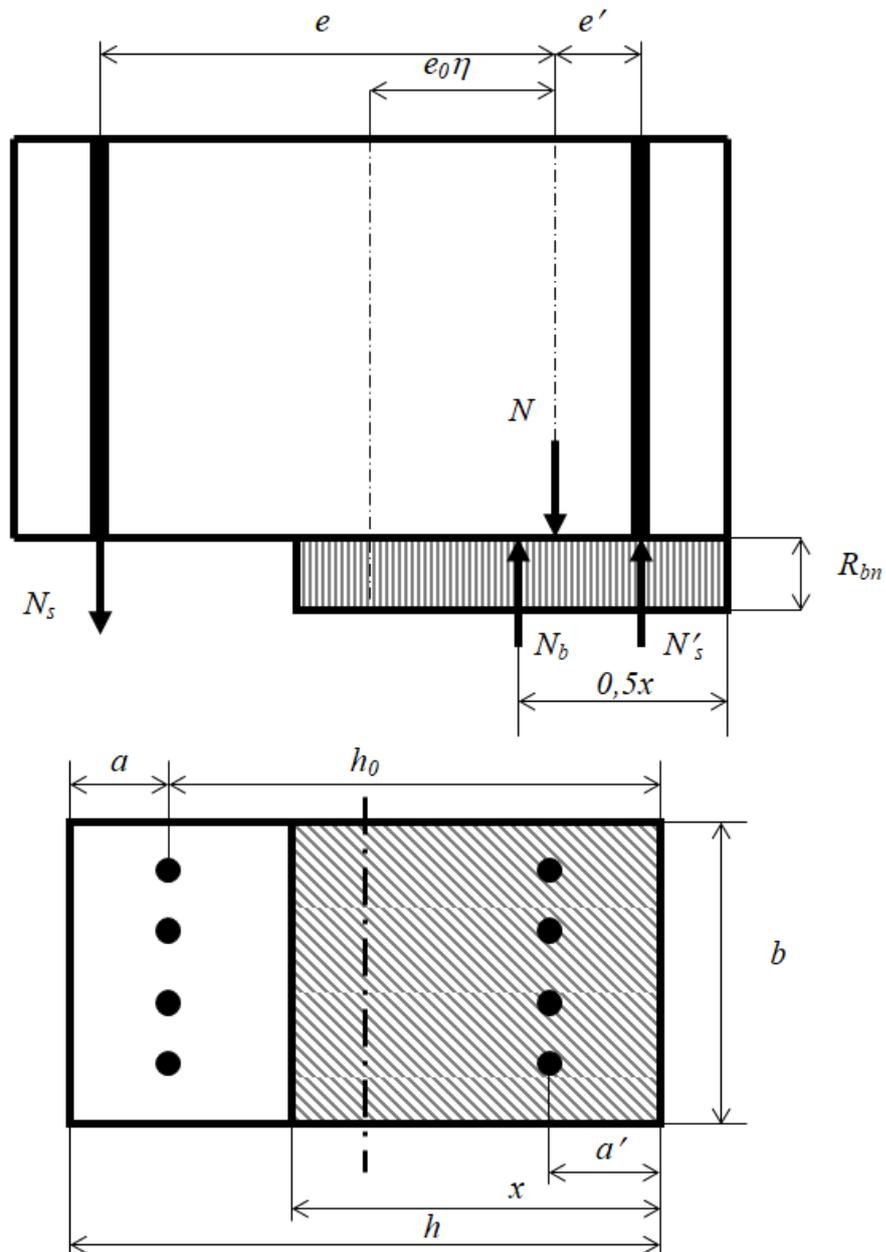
Розрахункова схема залізобетонної колони для випадку 2
